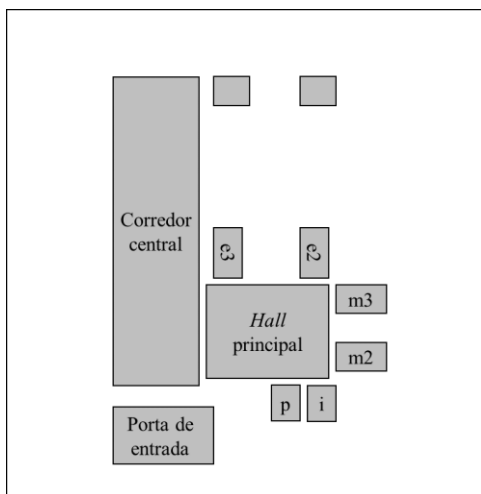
Recorte da planta do CS Morro da Ilha – Porta de entrada e hall principal
